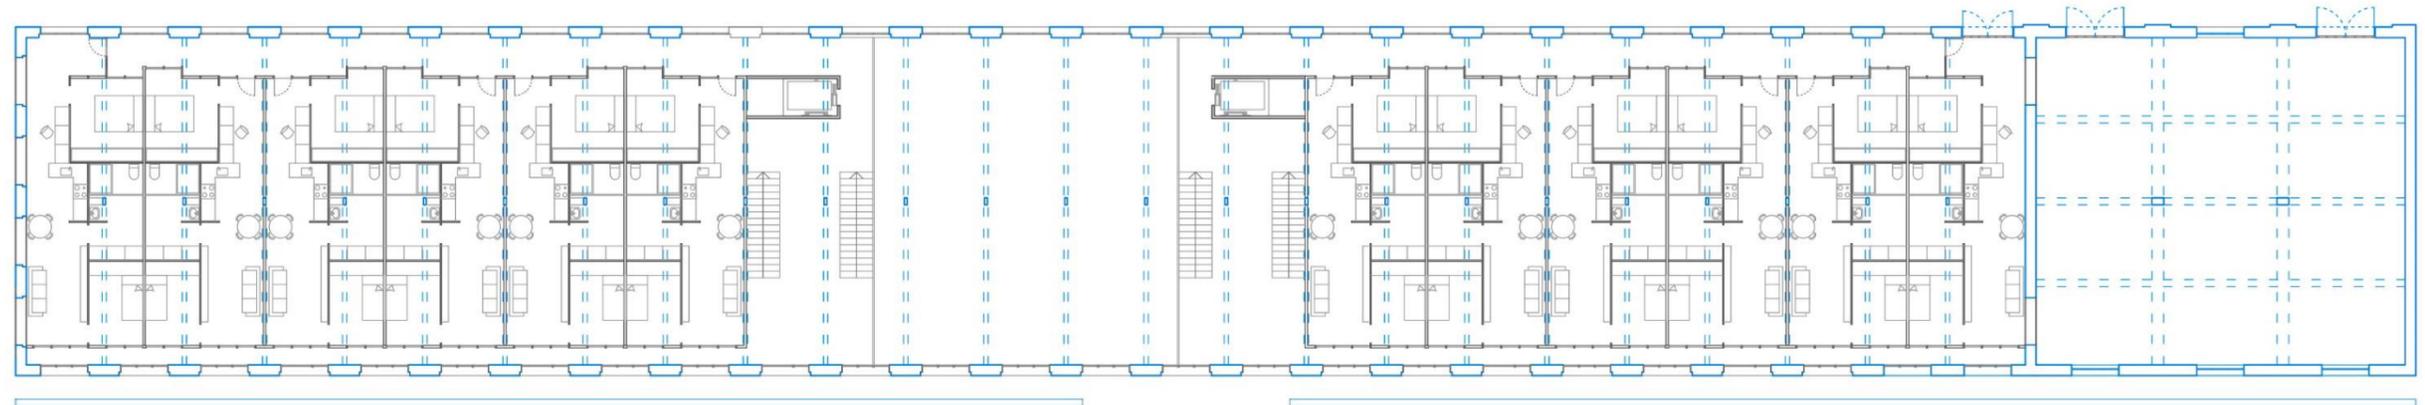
PLANO 1/300. Planta primera intervenció nave G fàbrica Fabra i Coats.
